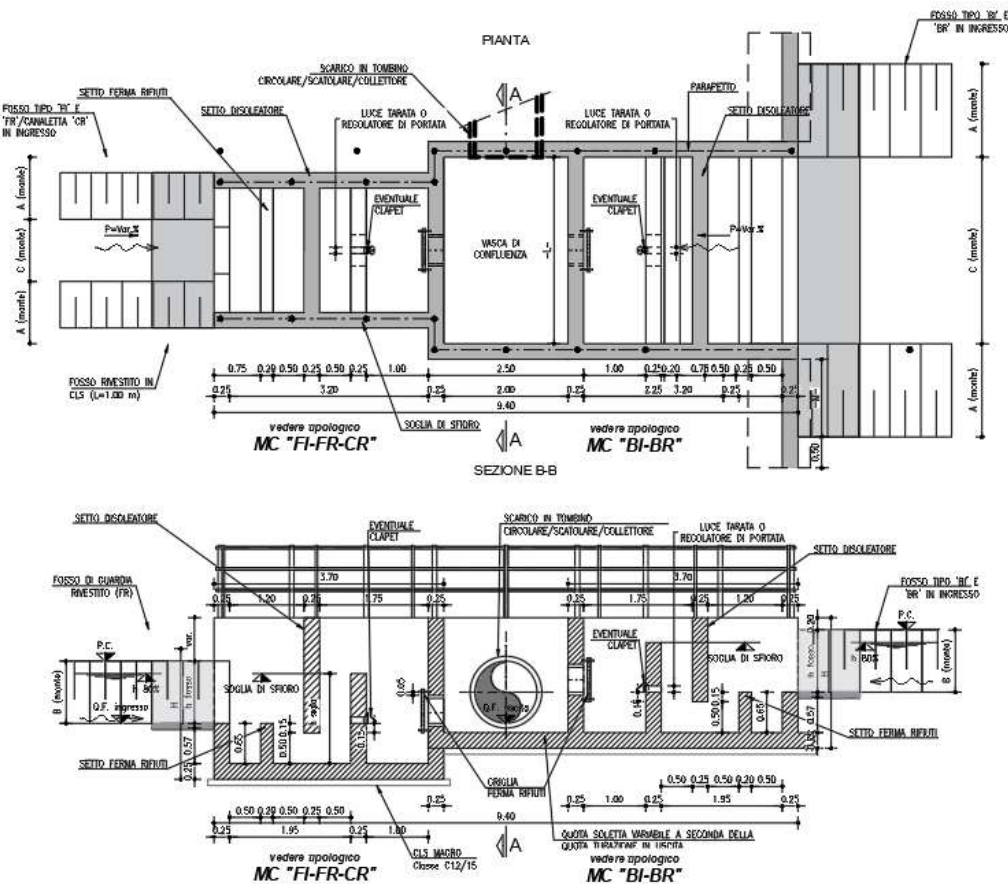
Manufatto di confluenza doppio: pianta e sezione trasversale.
